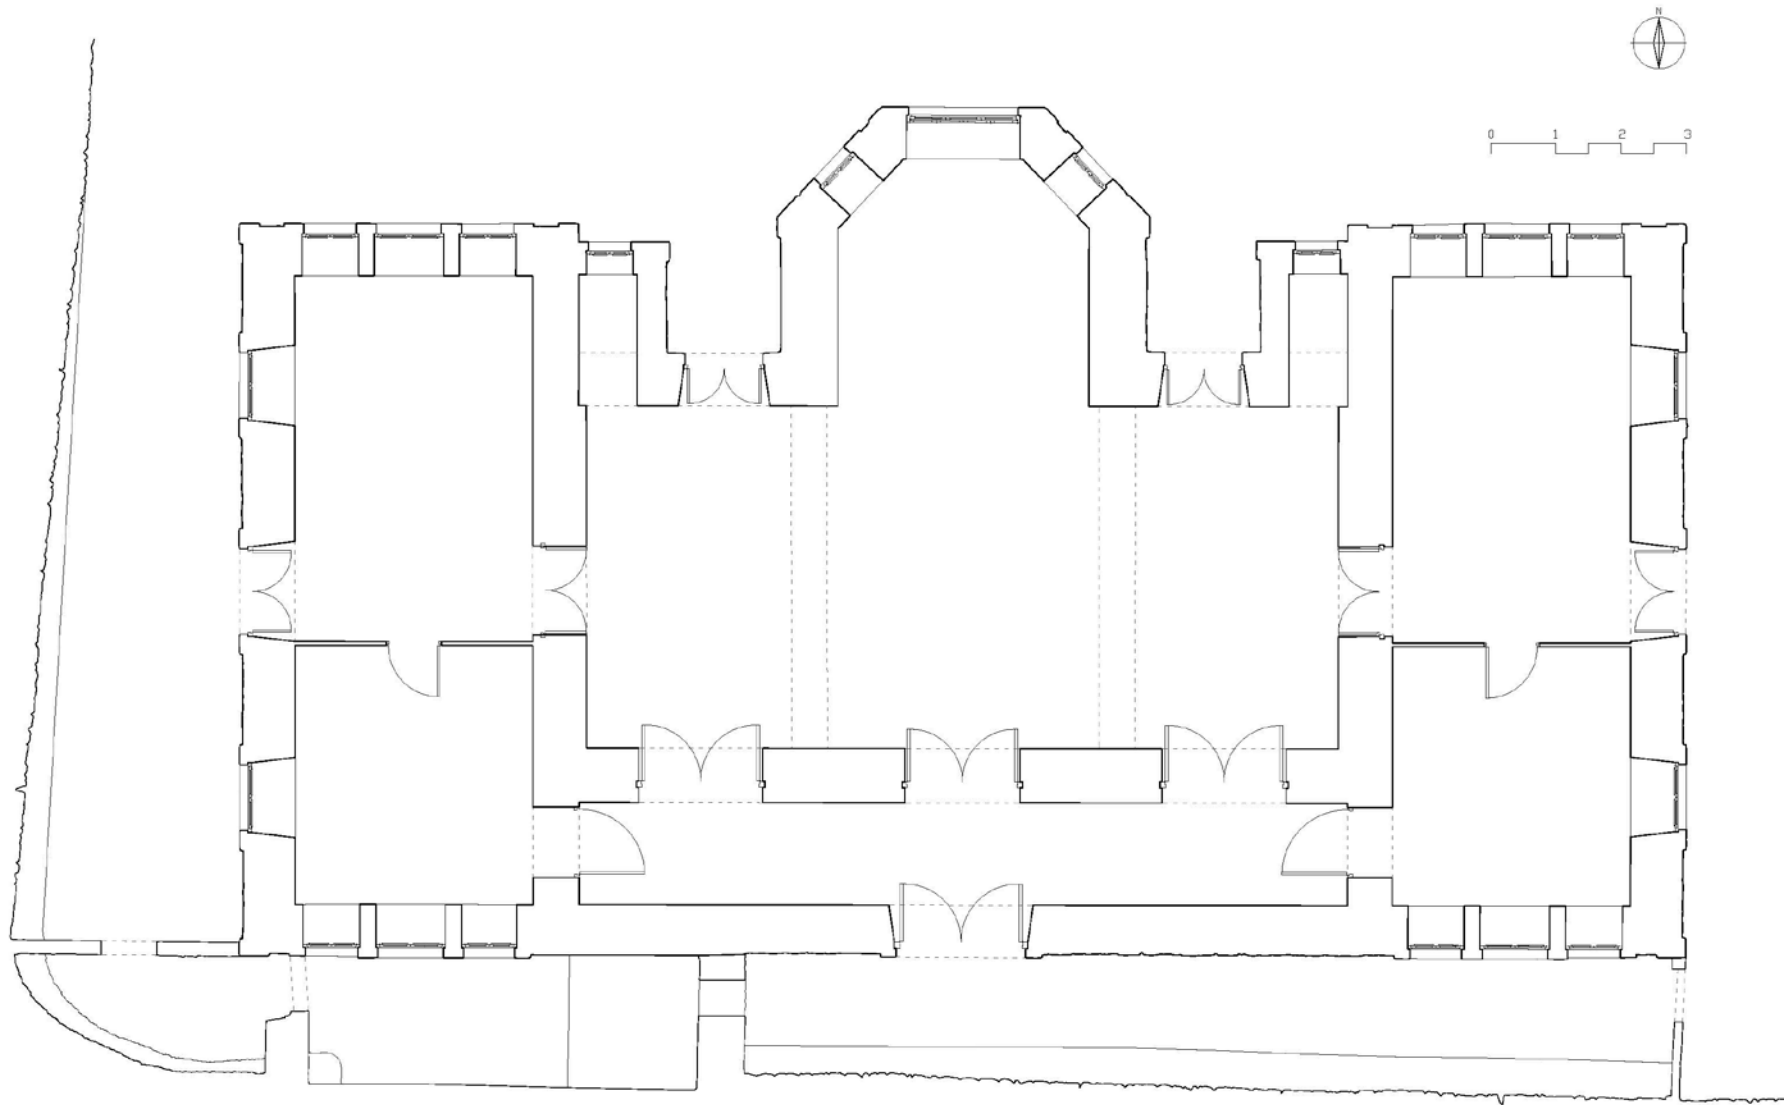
Plano sección horizontal planta baja. Estado original. Escala gráfica.
